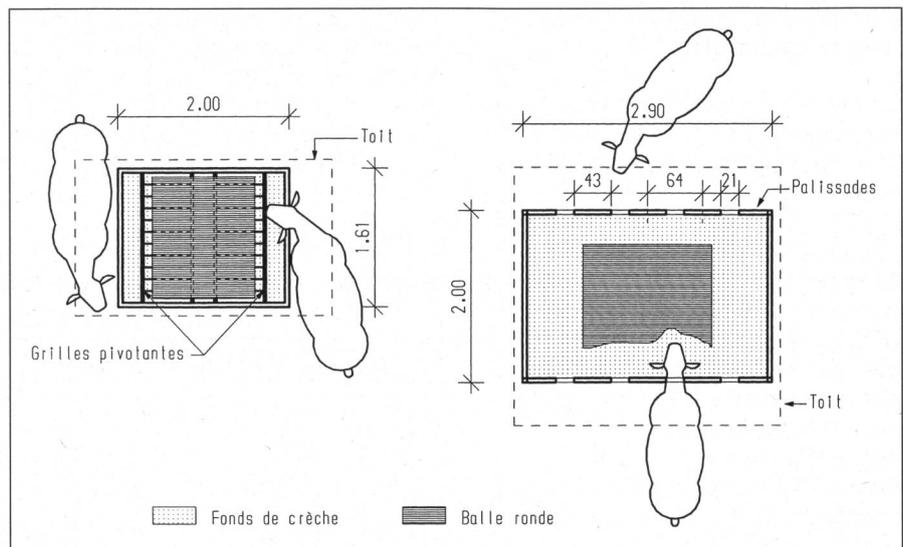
Du fait de l'absence de subdivision des places d'affouragement avec les râteliers à grilles pivotantes, deux vaches de rang hiérarchique élevé peuvent bloquer toute la largeur d'accès au râtelier. Les râteliers à palissade garantissent un affouragement bien plus calme pour toutes les vaches.
